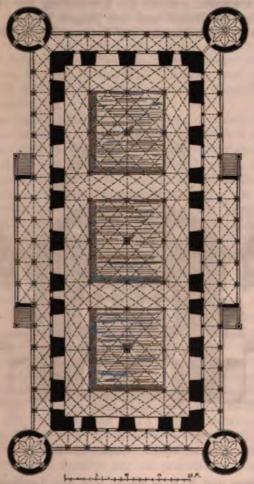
Lusthaus zu Stuttgart. Grundriss.
